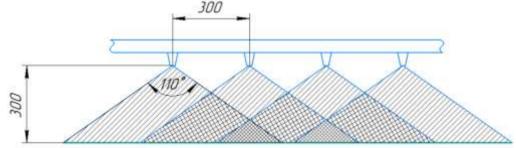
Зона перекрытия факела форсунок при высоте расположения 300 мм над покрытием
